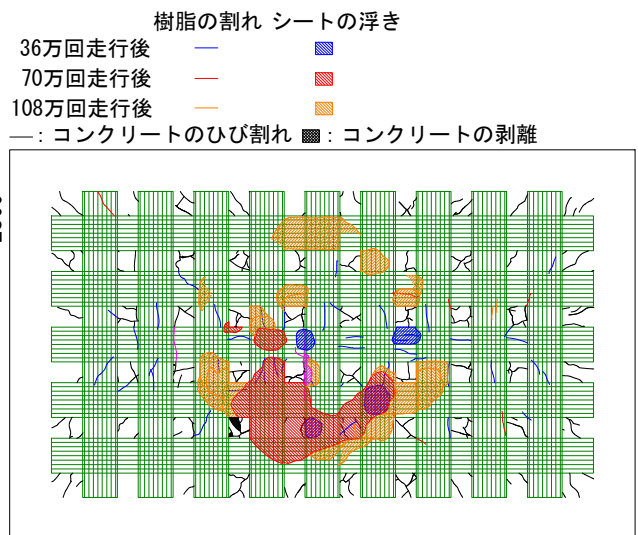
補強後のシートの浮き・樹脂の割れ、コンクリートのひび割れ・剥離状況
